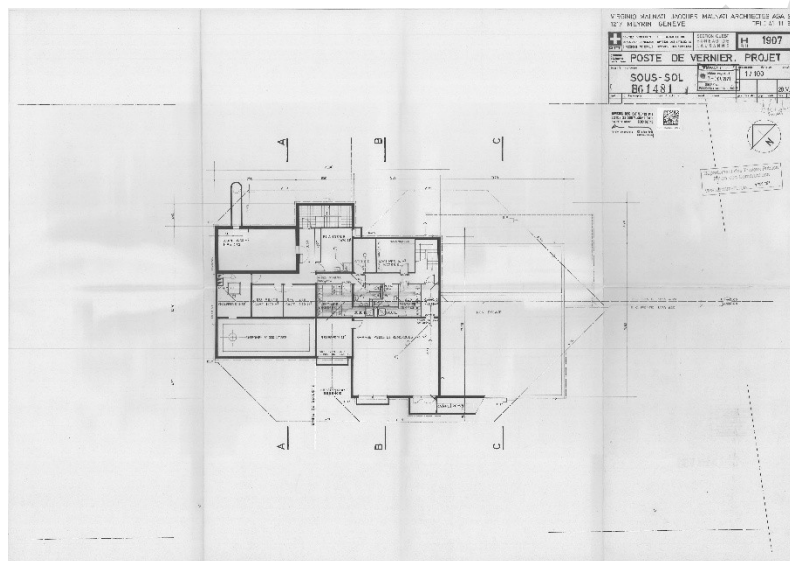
Ancien bureau de poste : Plan du sous-sol
